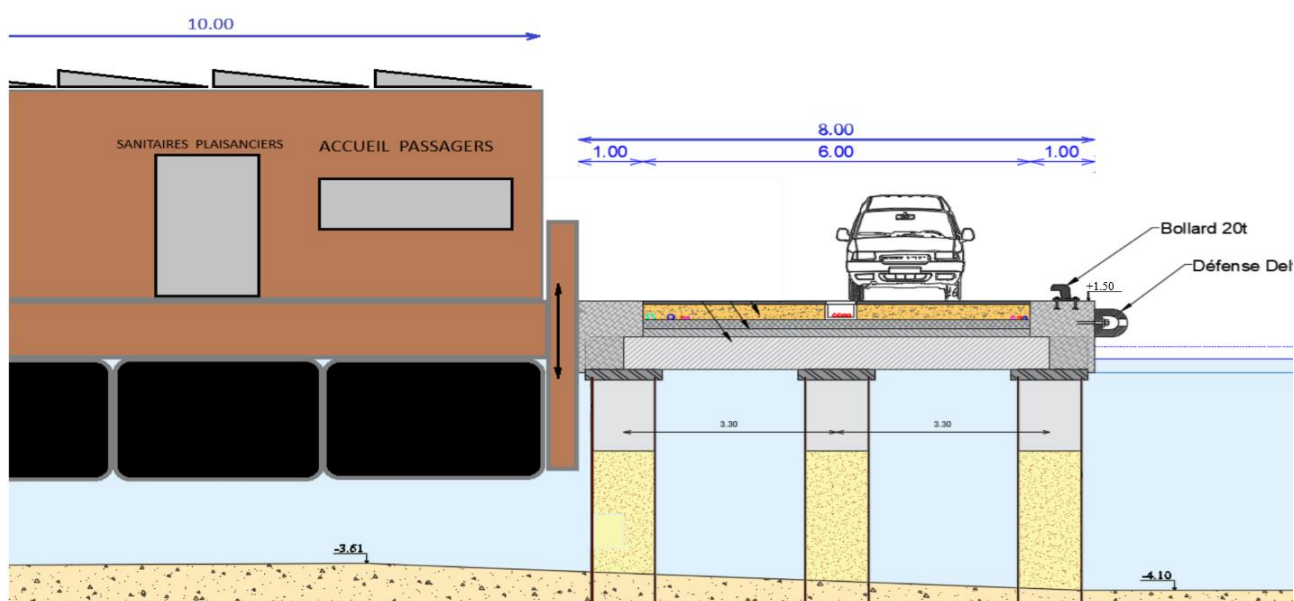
Plan en coupe bureau annexe de la capitainerie
